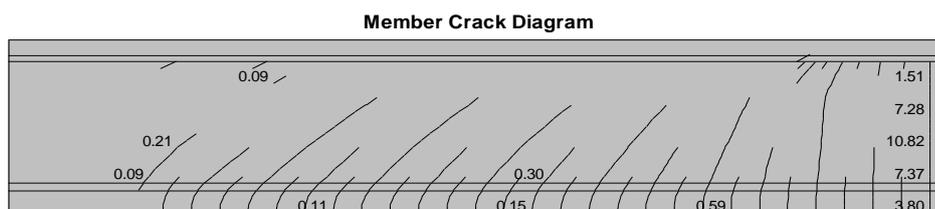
Pola retak awal balok beton pracetak BU4.
